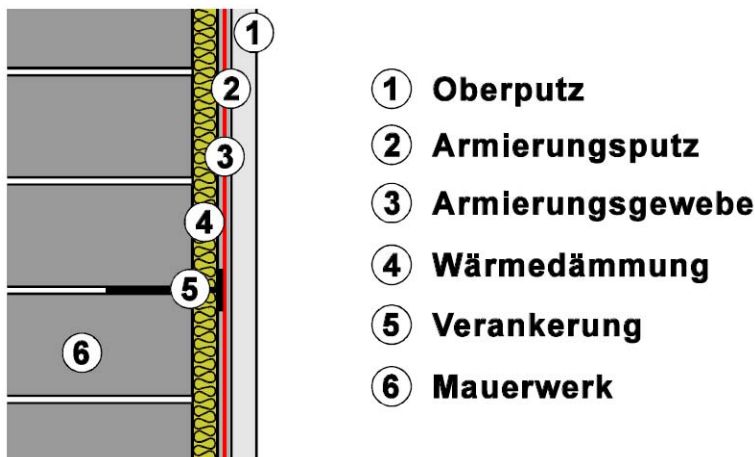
Aufbau eines Wärmedämmverbundsystems [Lit 6]
